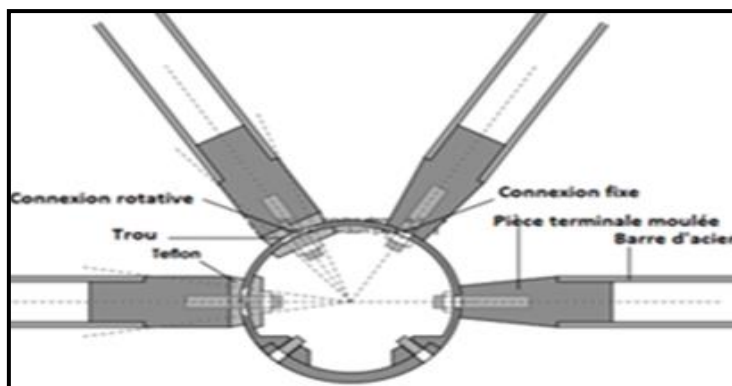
Détail constructif de la poutre tridimensionnelle.
